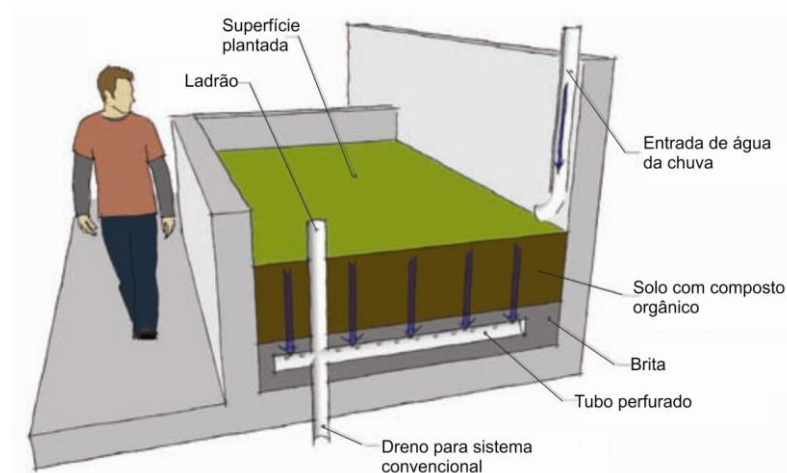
ESQUEMA DE CANTEIRO PLUVIAL
